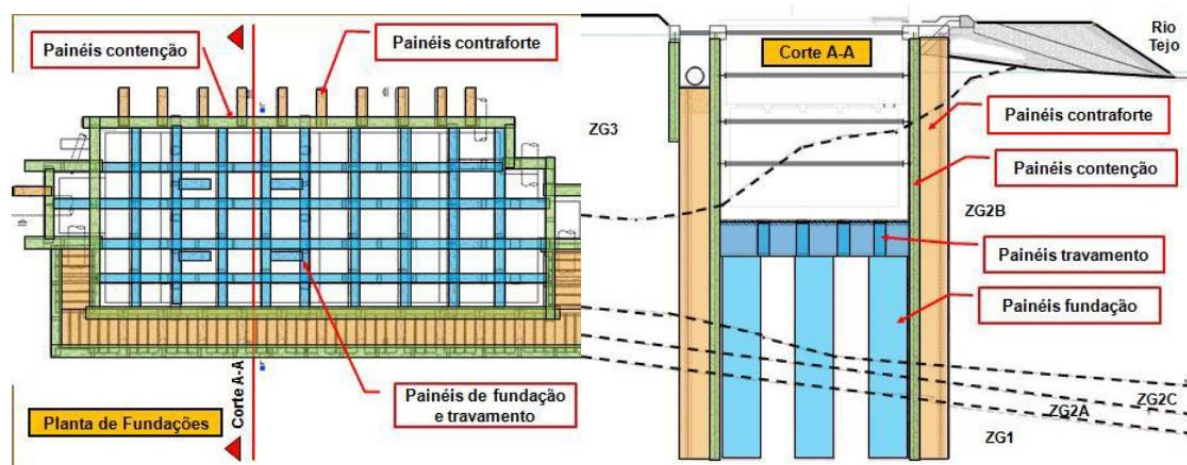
Planta e corte da estrutura de suporte da escavação da estação elevatória (Matos Fernandes, *et al.*, 2010).
